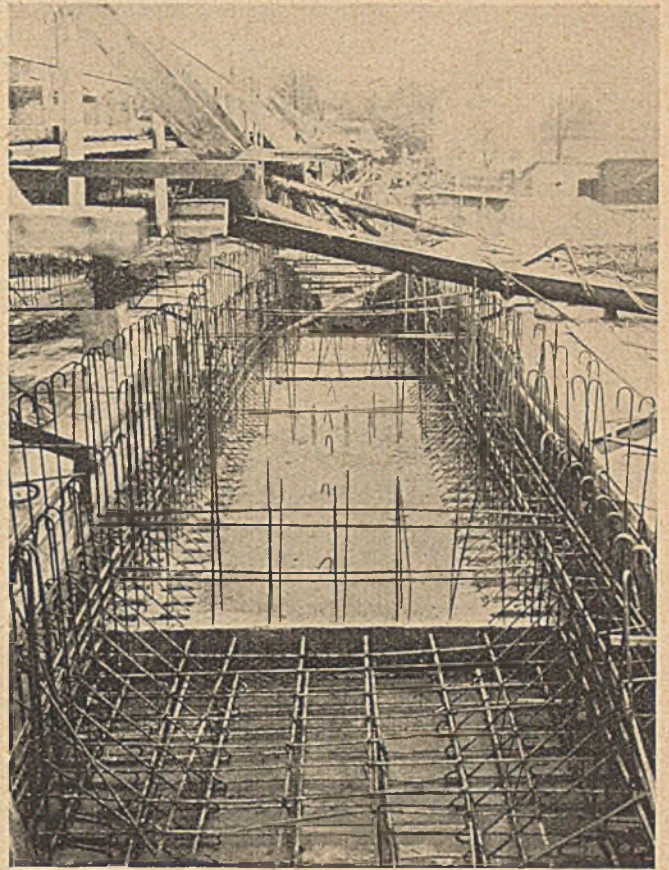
Betonierung der unteren Druckplatte eines Kastengewölbes.
